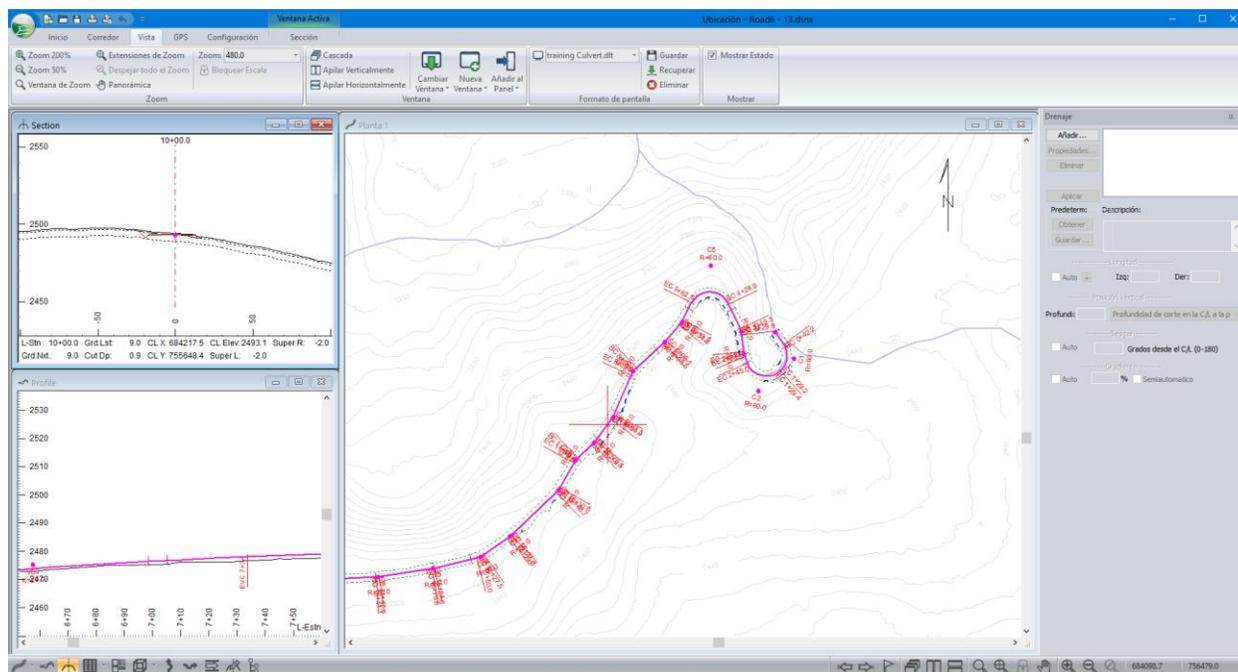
Formato de Pantalla: training Culvert.dlt
